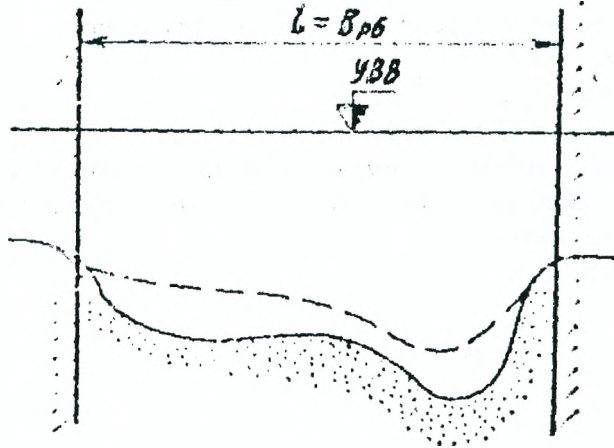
Расчетная схема для моста, перекрывающего только русло реки
